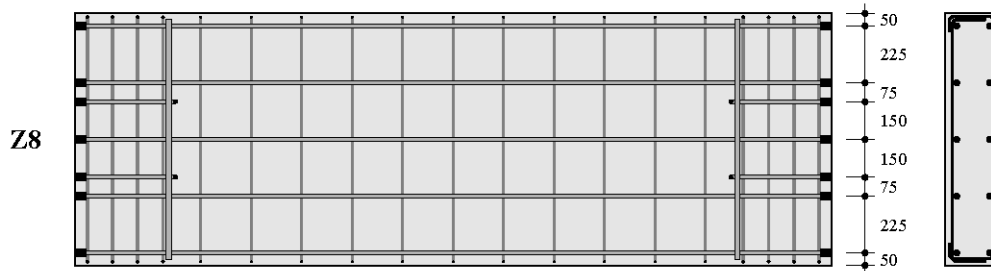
Bewehrungsführung des Versuchskörpers Z8 (aus [2])
